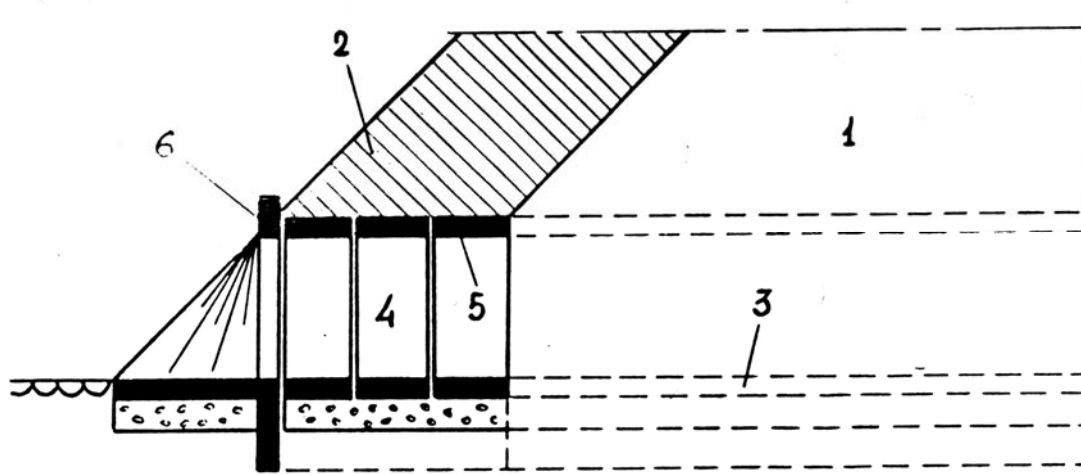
Удлинение прямоугольной трубы: 1 – существующая насыпь; 2 – уширение насыпи; 3 – существующий фундамент; 4 – новые стенки трубы; 5 – плиты перекрытия; 6 – портал
